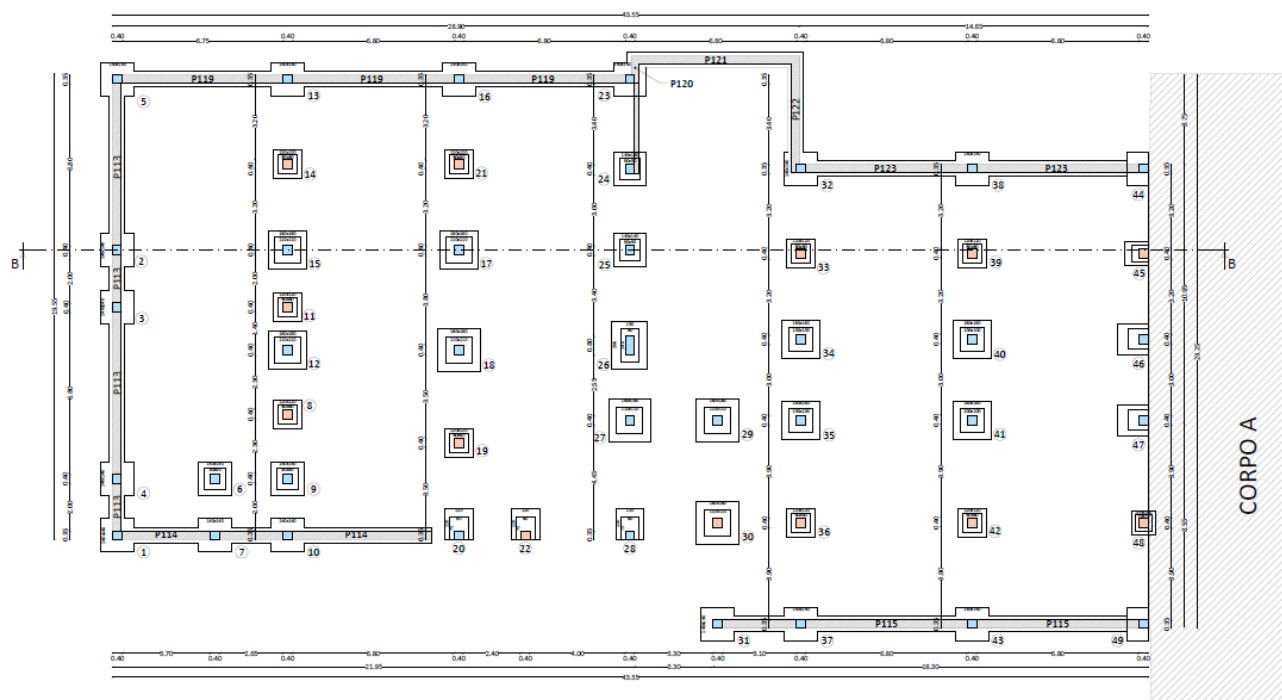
Blocco B-Planimetria Struttura di Fondazione Esistente.
